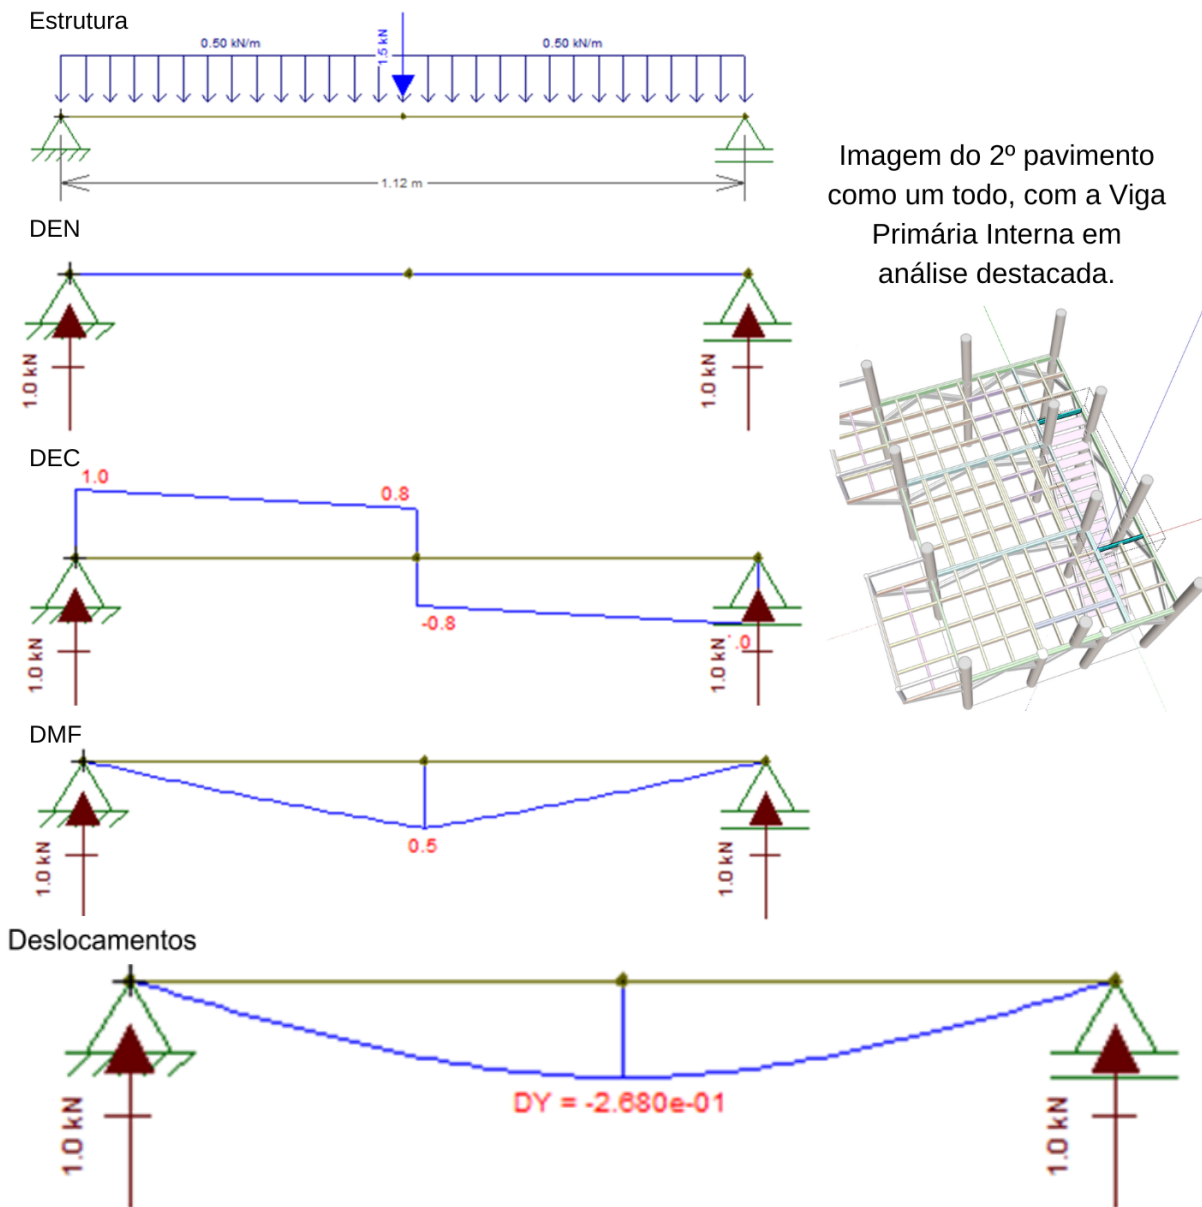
Esquema e análises estruturais de uma das vigas secundárias
